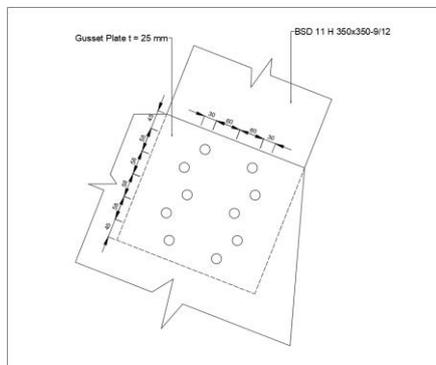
Konfigurasi Sambungan Baut jembatan profil BSB 6
